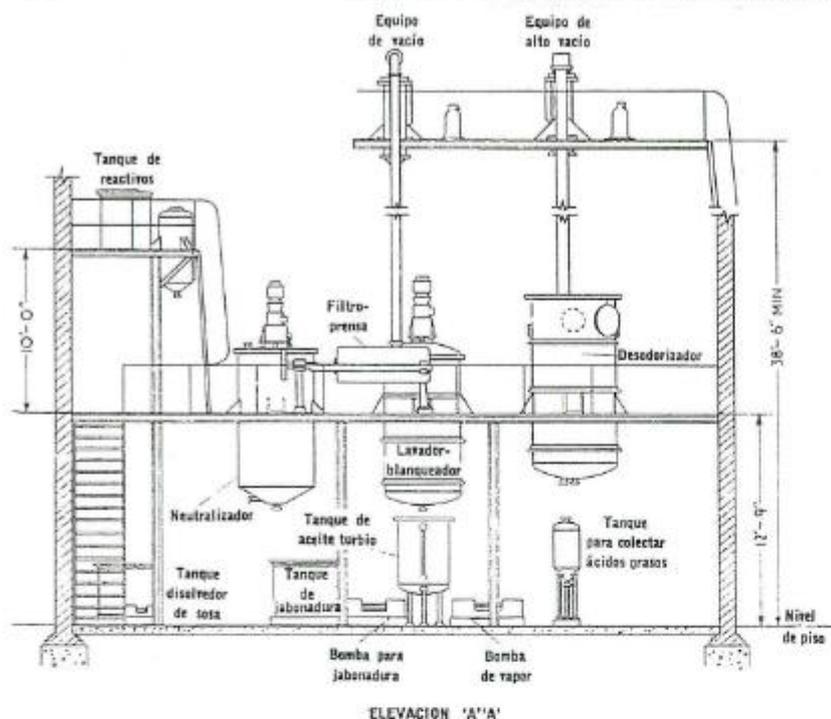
Planta refinadora —elevación. (Cortesía de Constructors John Brown Ltd. London)
